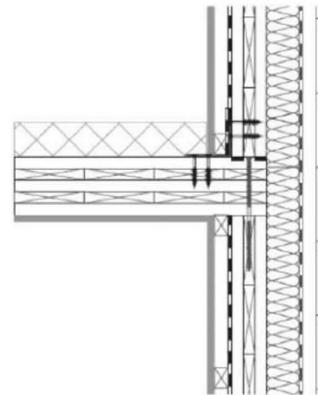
Appui entre panneaux de mur et de plancher assemblé par équerre métallique
